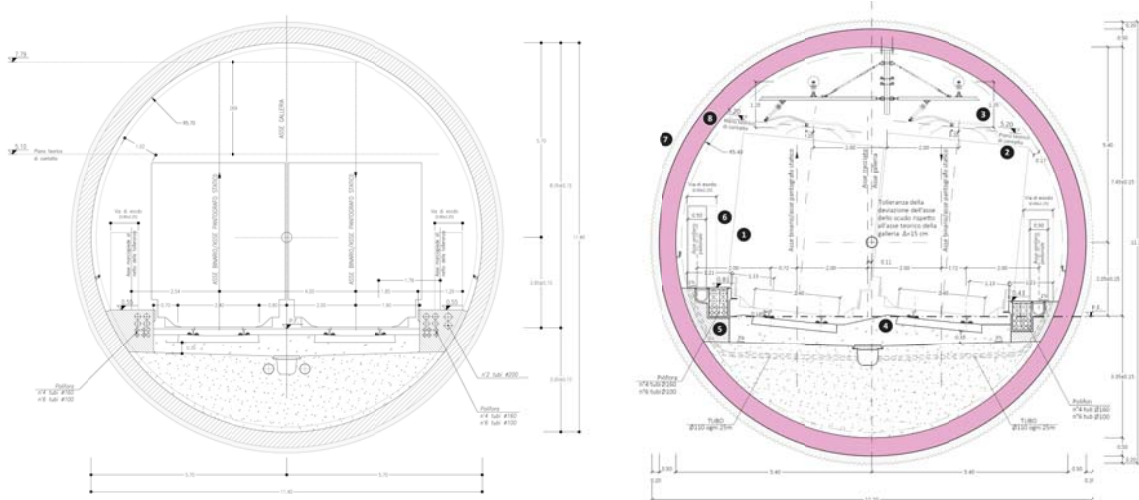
Sezione tipo prevista in gara (a sinistra) e prevista in gara (a destra)
